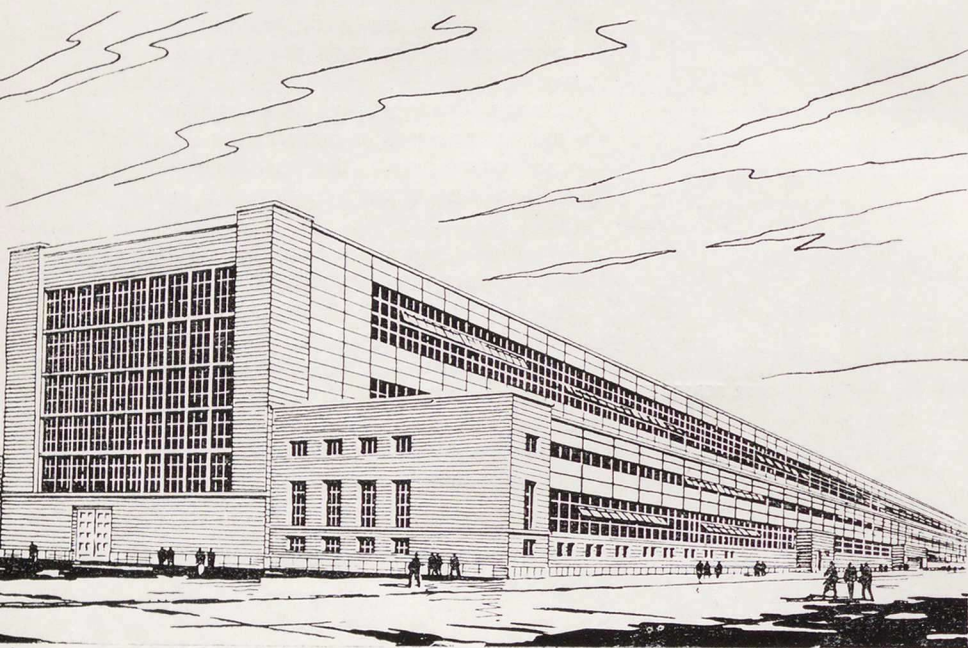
Ново-Криворожский горнообогатительный комбинат. Корпус обогащения. Перспектива. Институт ЛенПСП
